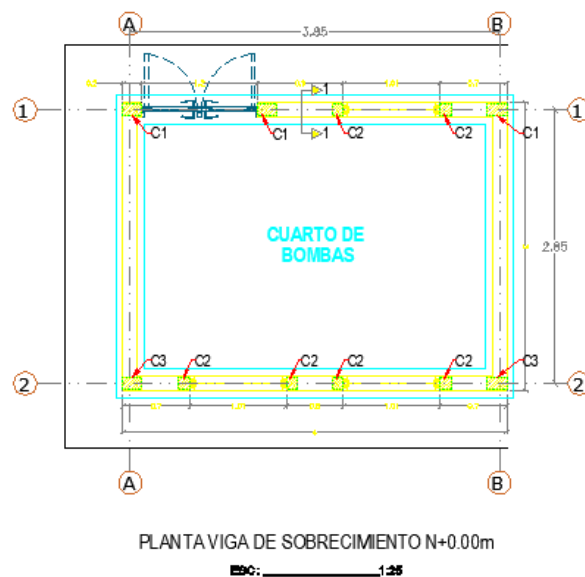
Planta viga de sobrecimiento AUTOCAD.
